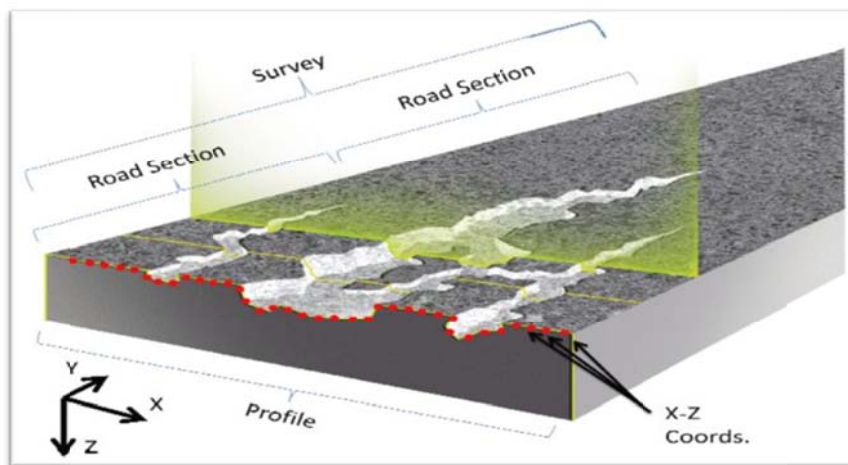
Rilievo degli ammaloramenti delle pavimentazioni
